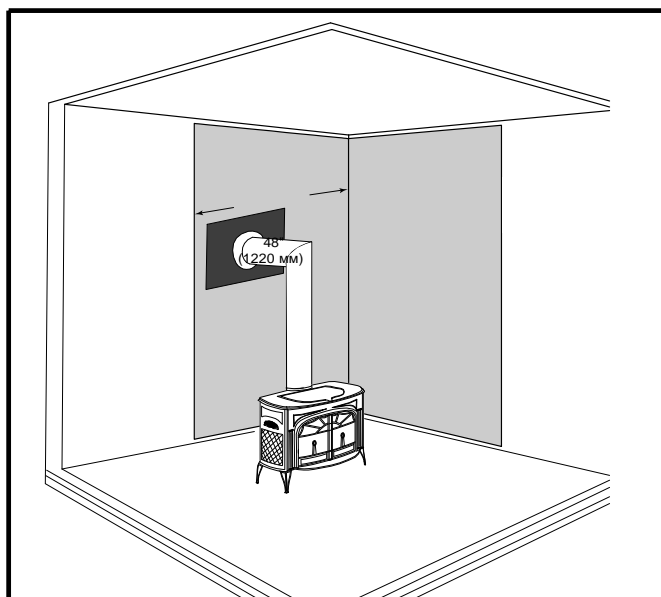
Параллельная установка с проходом через заднюю стену, 2 защитных покрытия стены. Сокращенное расстояние, как до задней, так и до боковой стены. При желании защитные покрытия стен могут соединиться в углу. Защита соединительного элемента расположена в центре за соединительным элементом. Проход через стену должен соответствовать стандартам
